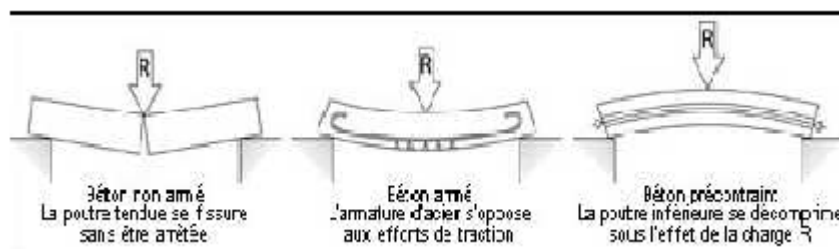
comparaison d'une poutre en béton armé et poutre en béton précontraint
